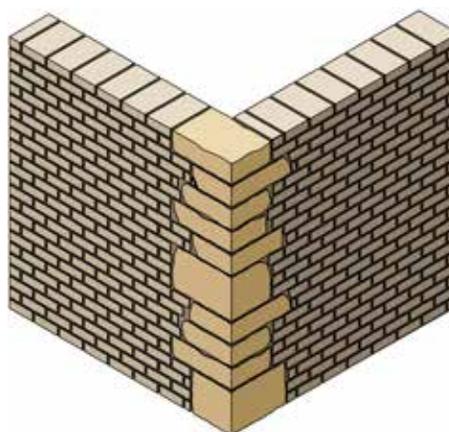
Traslape de piezas de cantera, como refuerzo estructural en aristas de muros de adobe.
